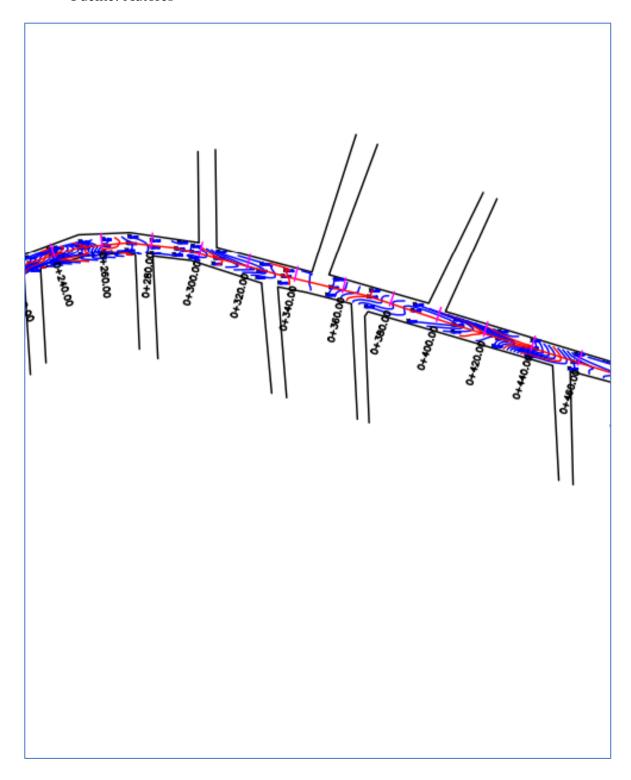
Vista 3 de plano con abscisado y perfil longitudinal
